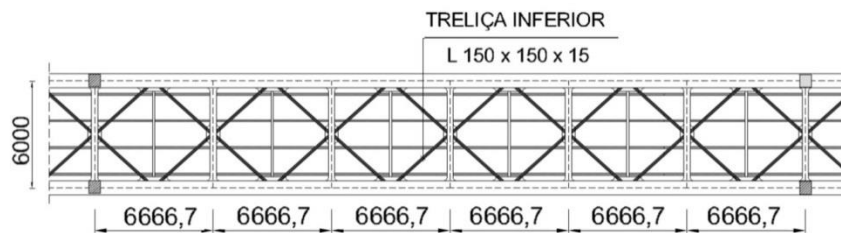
Vista inferior detalhada do tabuleiro com dimensões em mm (Figueiredo, 2007)
